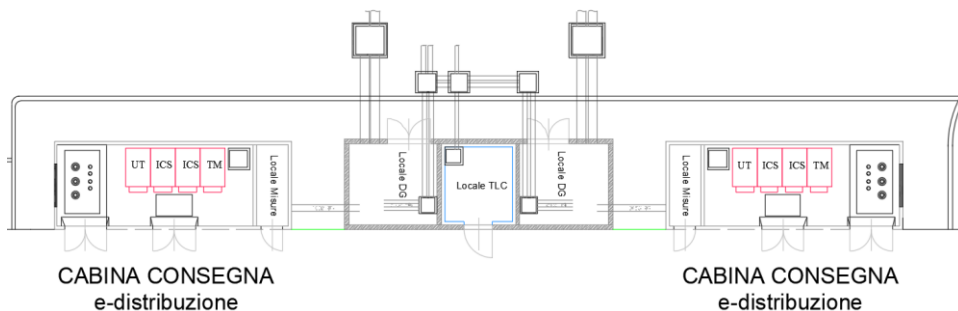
Planimetria tipologica edificio punti di consegna linee MT e TLC
